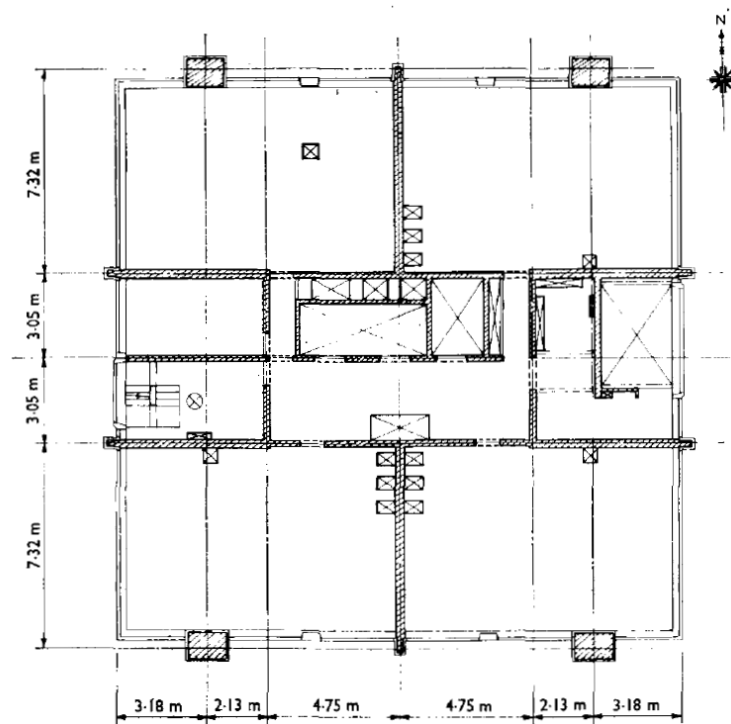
Hyde Park Cavalry Barracks – Plano Superestructura Típica (Hooper, 1973)
